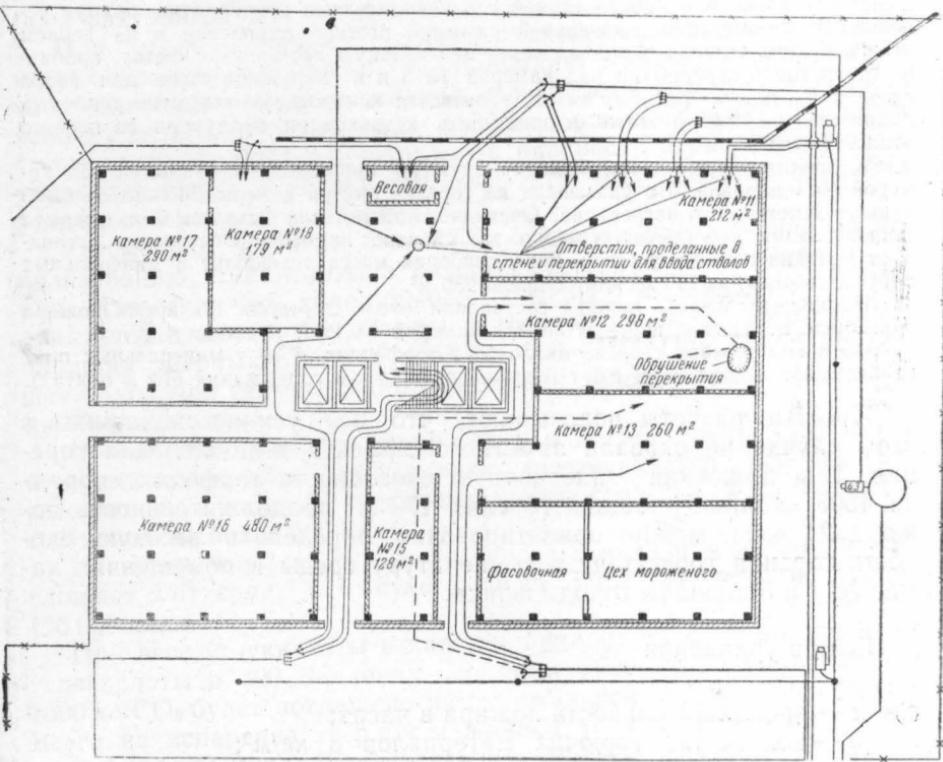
План первого этажа холодильника и схема прокладки рукавных линий.
